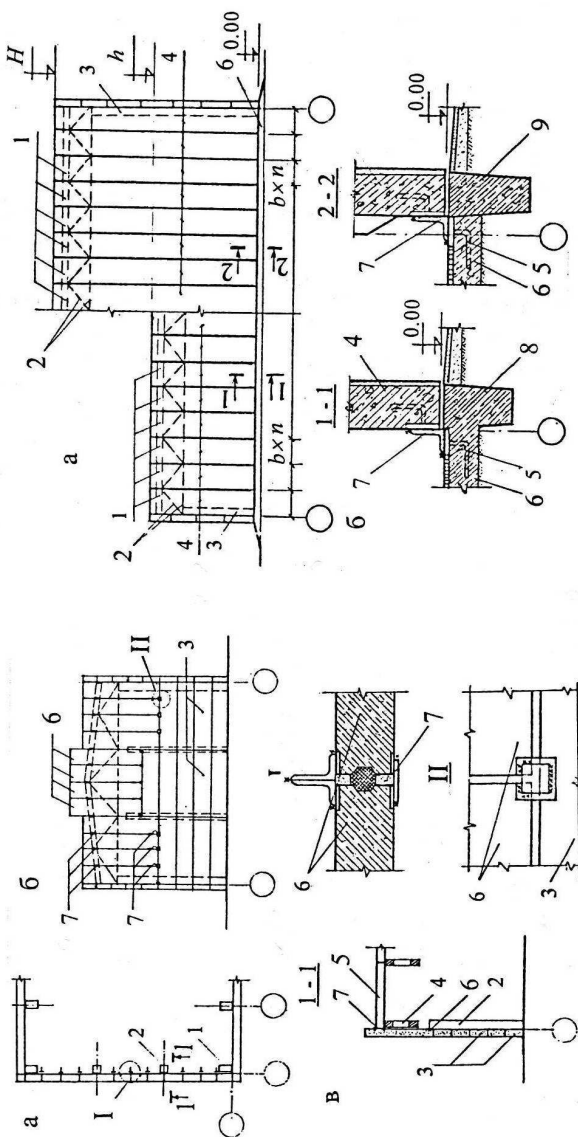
Торцевая стена промышленного здания с вертикальной разрезкой фронтона
